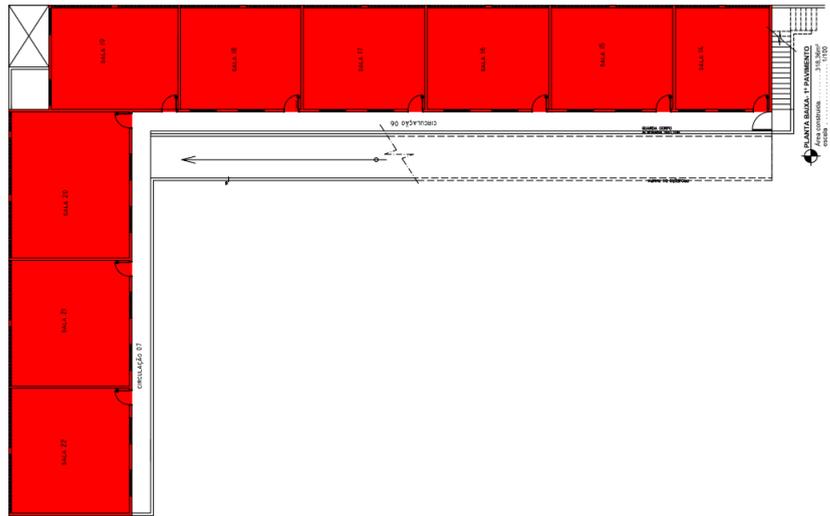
Planta baixa do pavimento térreo da Escola Estadual Engenheiro Caldas
